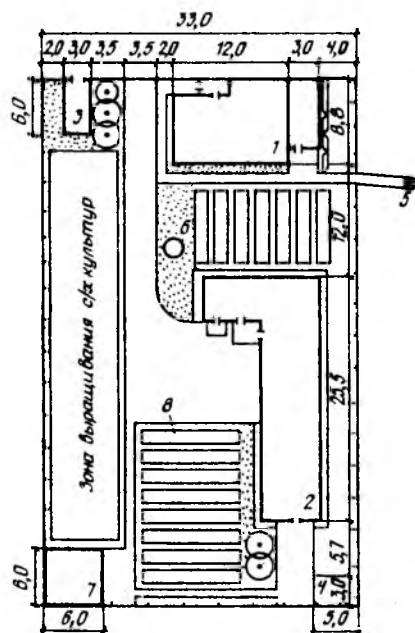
Генеральный план кроликофермы на 50 крольчих:
